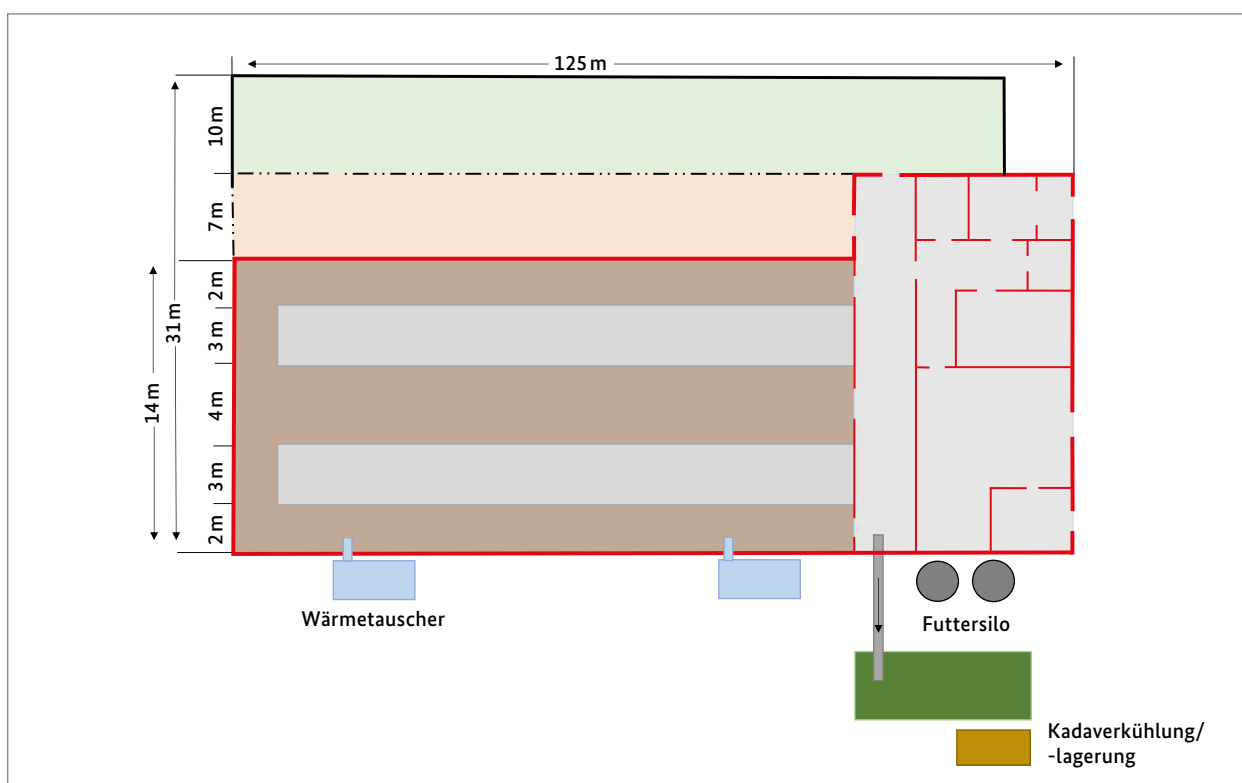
Grundriss des Planungsbeispiels.
